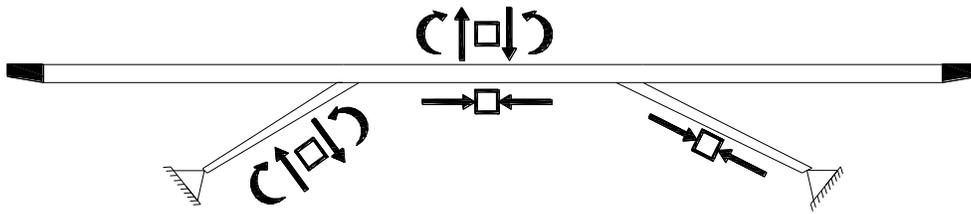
Puente tipo viga con miembros inclinados sujetos a compresión y flexión.
